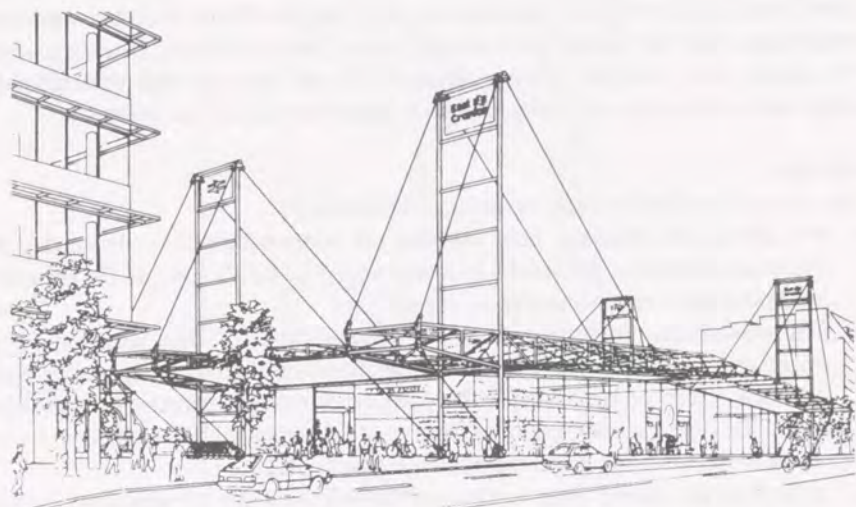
Voorbeeld van een grote vrije overspanning met een beperkt eigen gewicht: British Rail-station East Croydon
